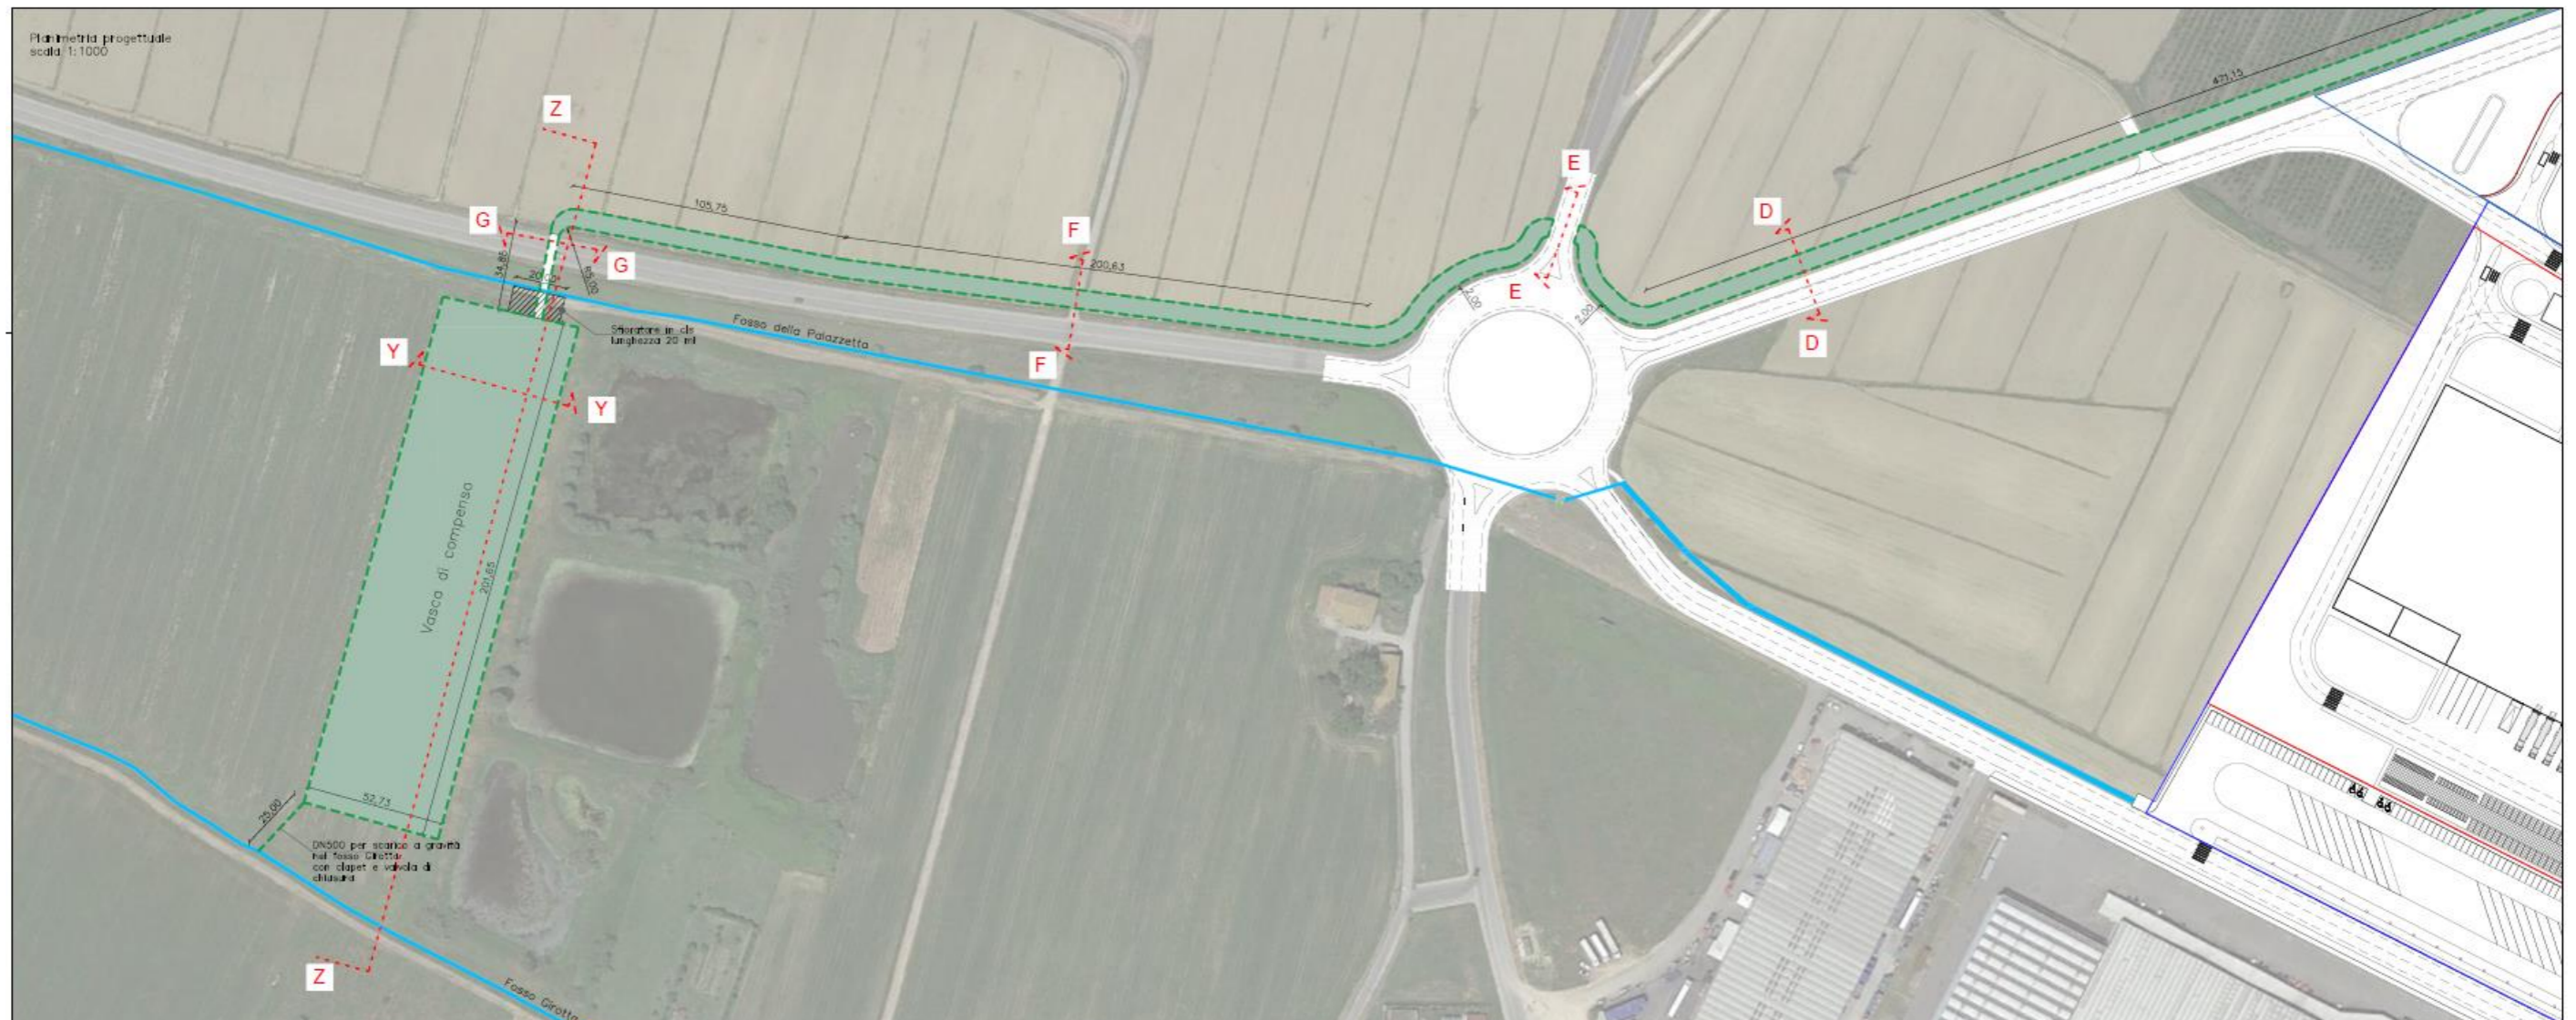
Planimetria con indicazione delle opere di drenaggio e cassa di compensazione. Stato di progetto.
